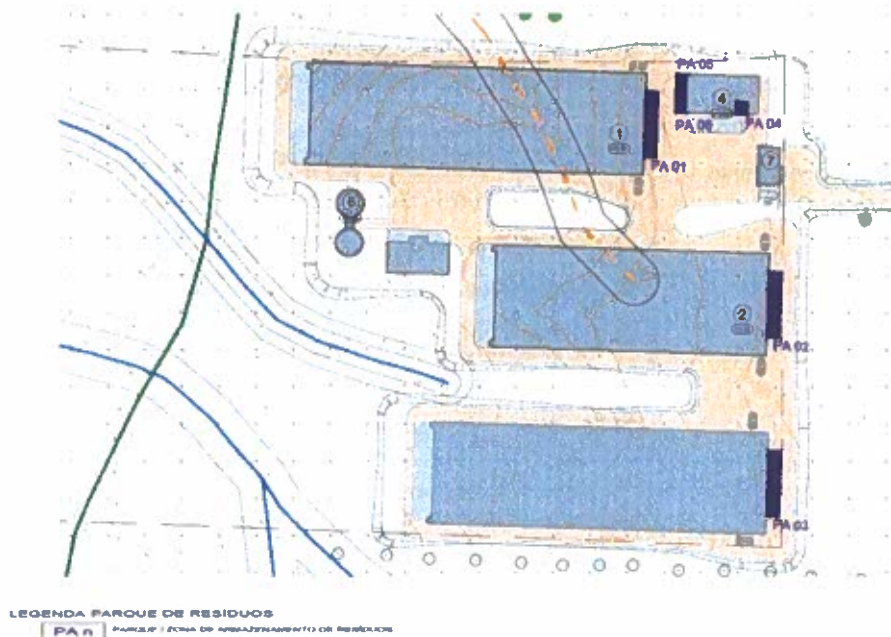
Extrato da planta de implantação das áreas de armazenamento de resíduos
